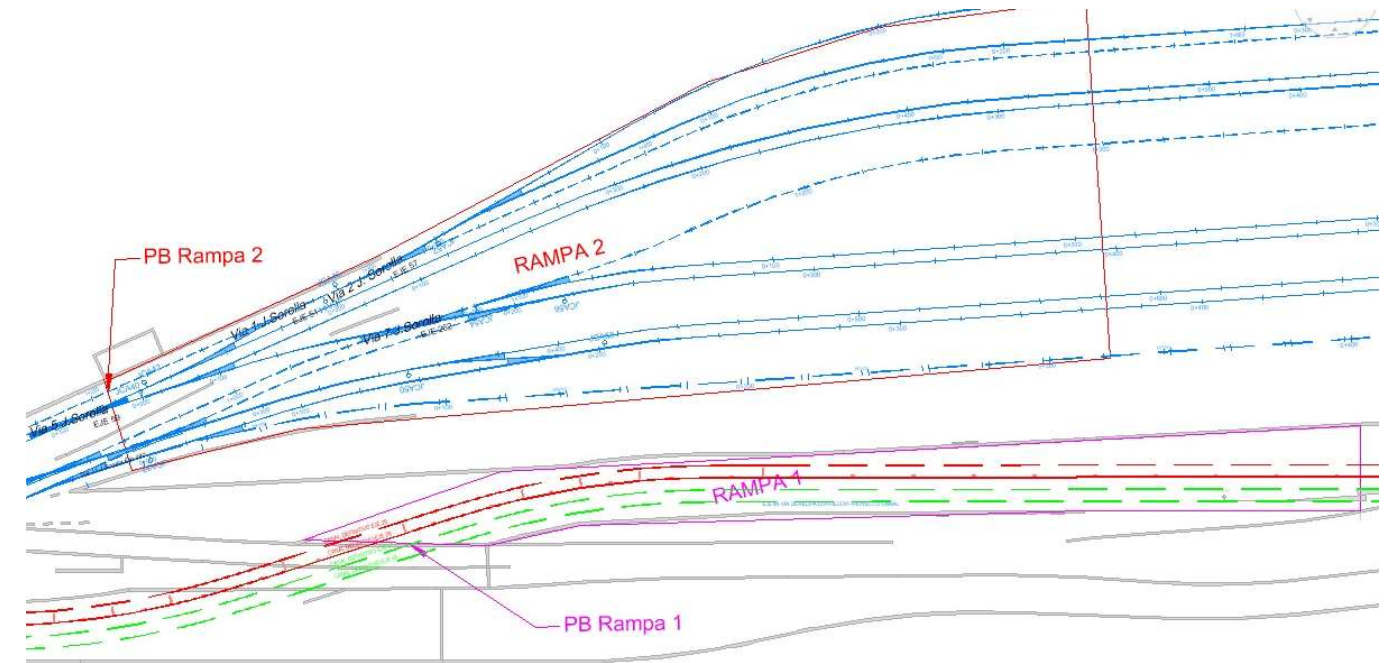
Planta de configuración de las rampas modificadas con los puntos bajos de las mismas. Fuente: Elaboración propia con planos de la oficina técnica
